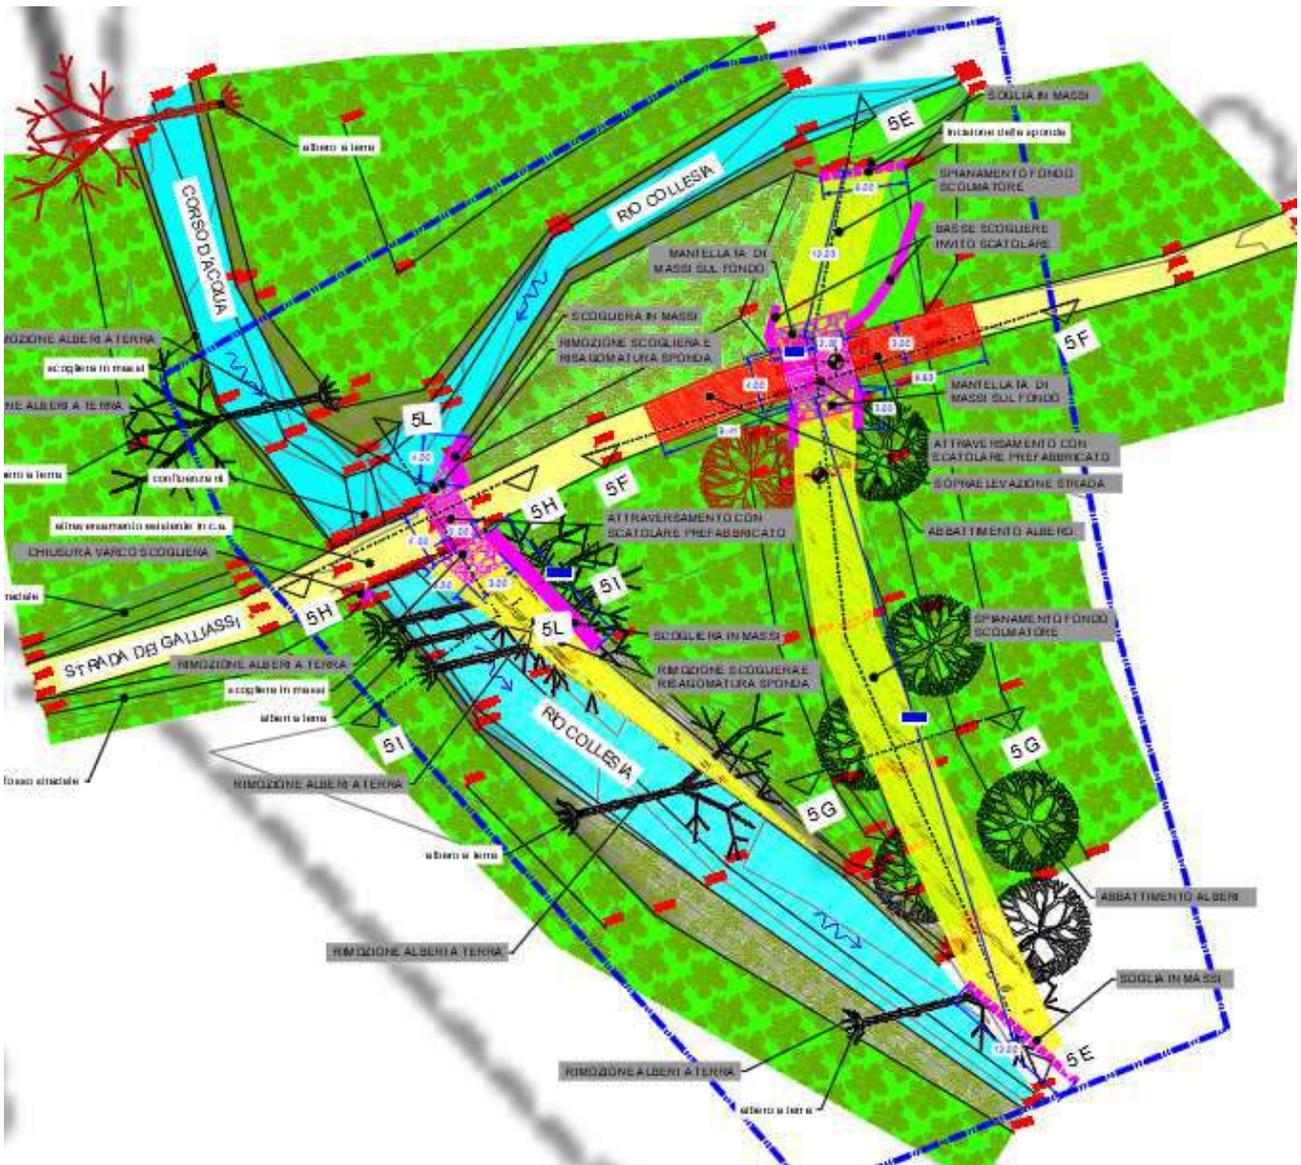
Planimetria di progetto. (rappresentazione non in scala)
